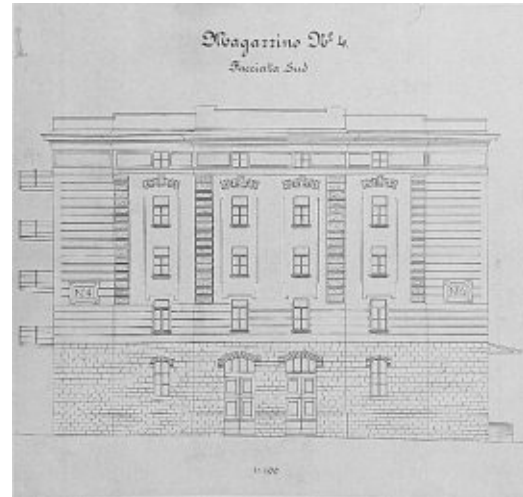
Lagerhaus 4, Ansicht Südfassade.
